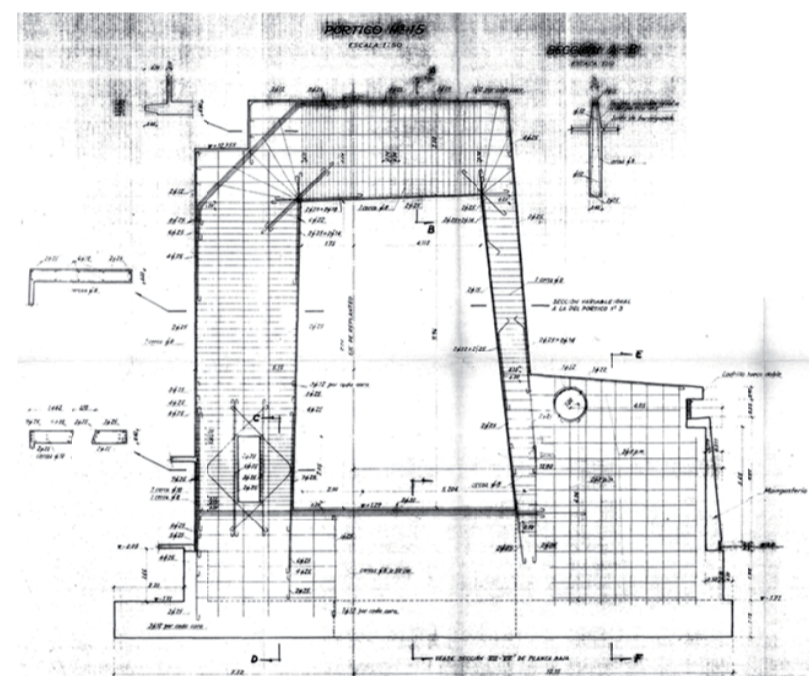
Pórtico 15 de Apoyo al Este se considera apoyo por no tener rigidez la lámina en el eje longitudinal.
